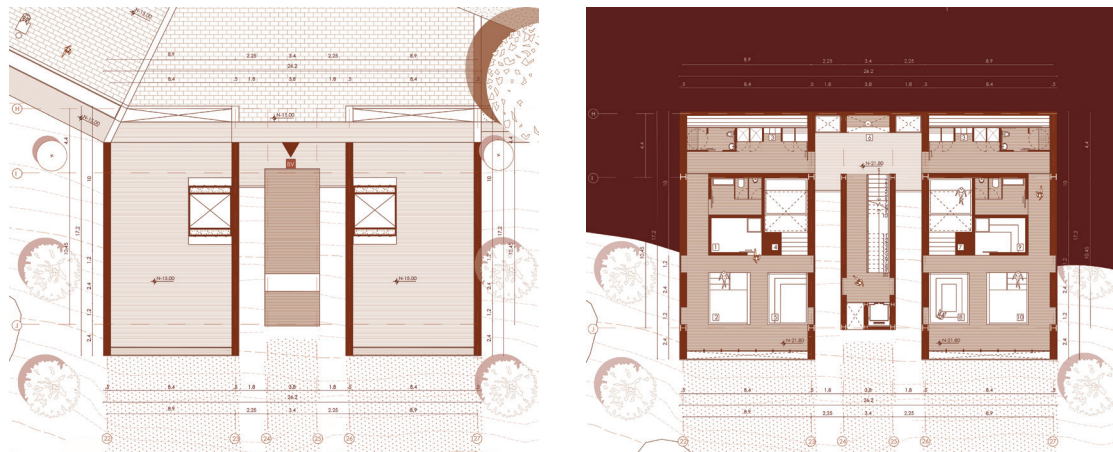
Bloque V. Planta de cubierta N-15.00 y Planta N-21.80
